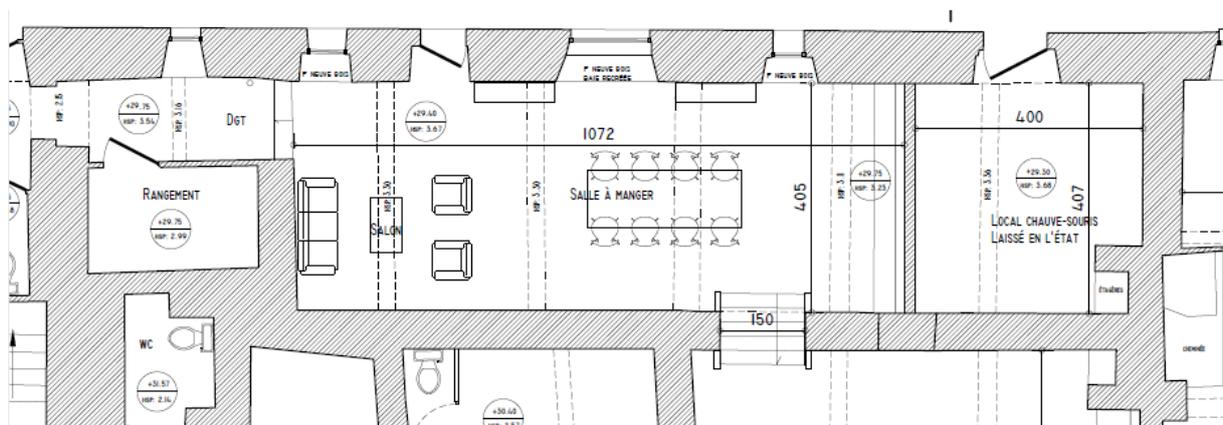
Plan d'aménagement suite au retrait de la cloison de 1m.
